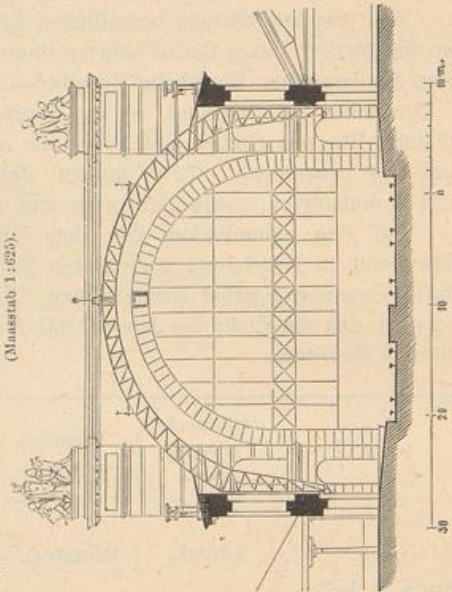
und 66. Empfangsgebäude der Berlin-Lehrter-Eisenbahn. Hauptfacade und Querschnitt durch die Halle. (Maassstab 1:6250).
